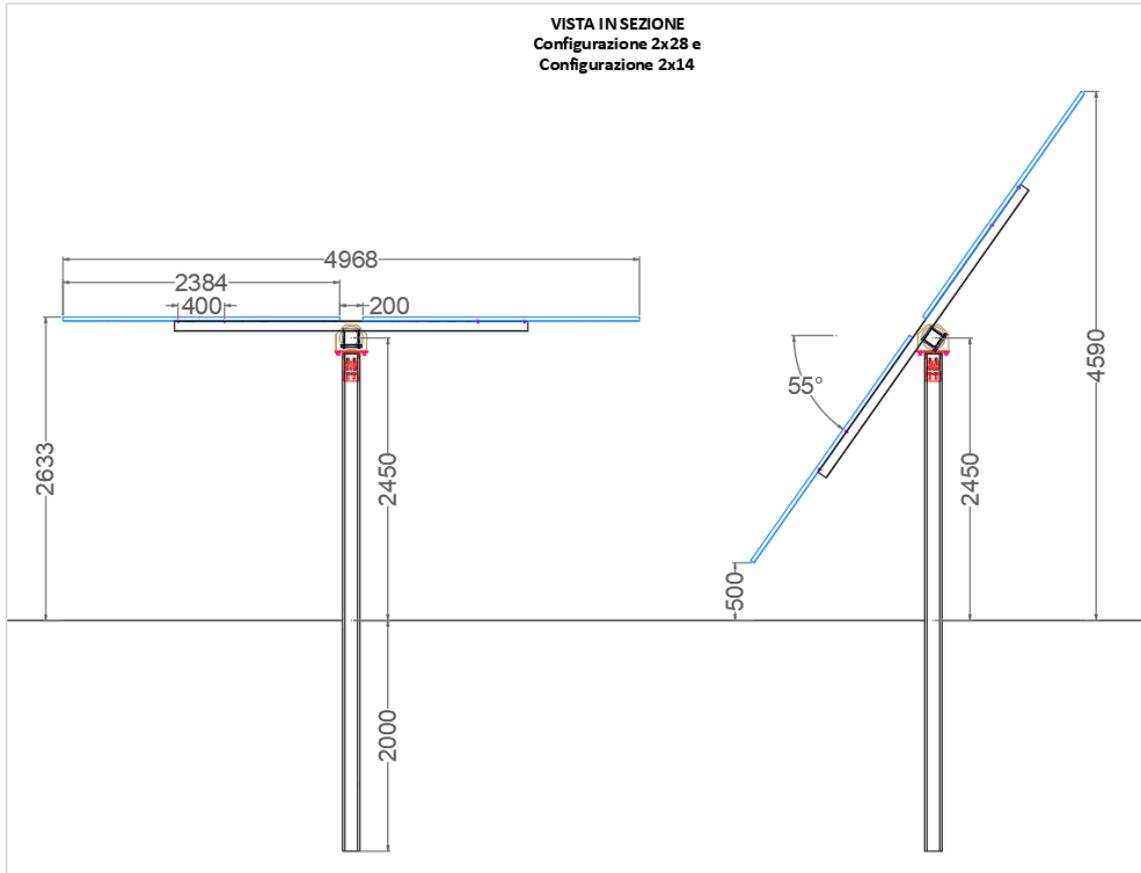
Vista in sezione delle strutture porta-moduli tracker 2x28 e 2x14
